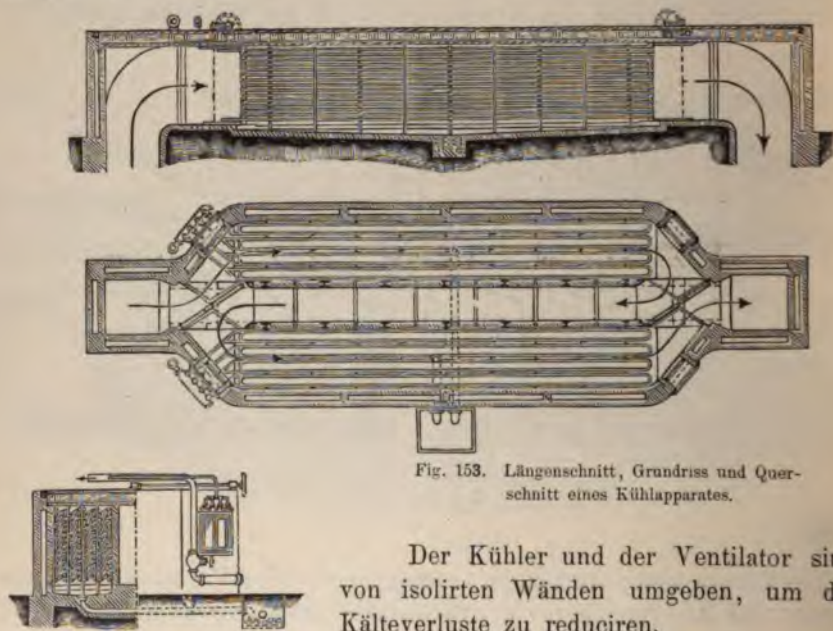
Längenschnitt, Grundriss und Querschnitt eines Kühlapparates.
